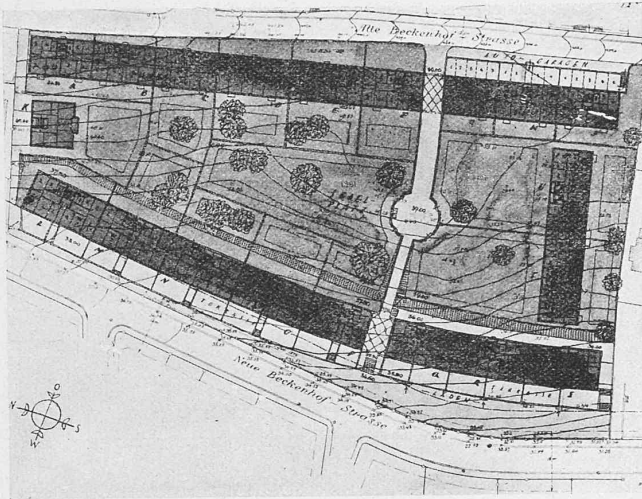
Lageplan 1:2000, unter Beseitigung des „Beckenhof“.
